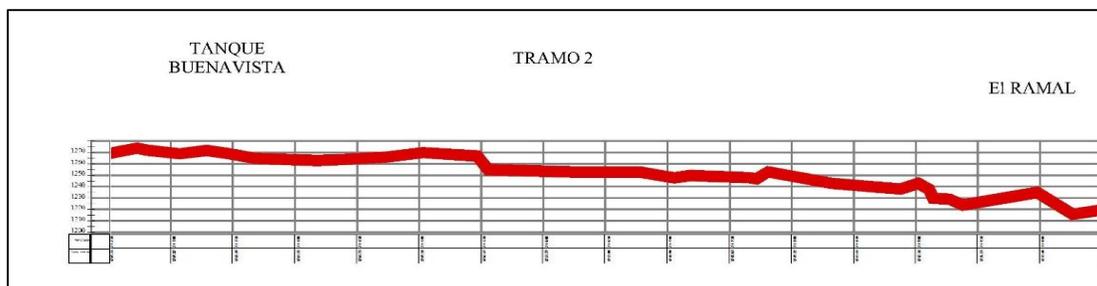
Perfil del terreno tramo tanque Buena Vista- Ramal. Fuente. Pasante del proyecto.
